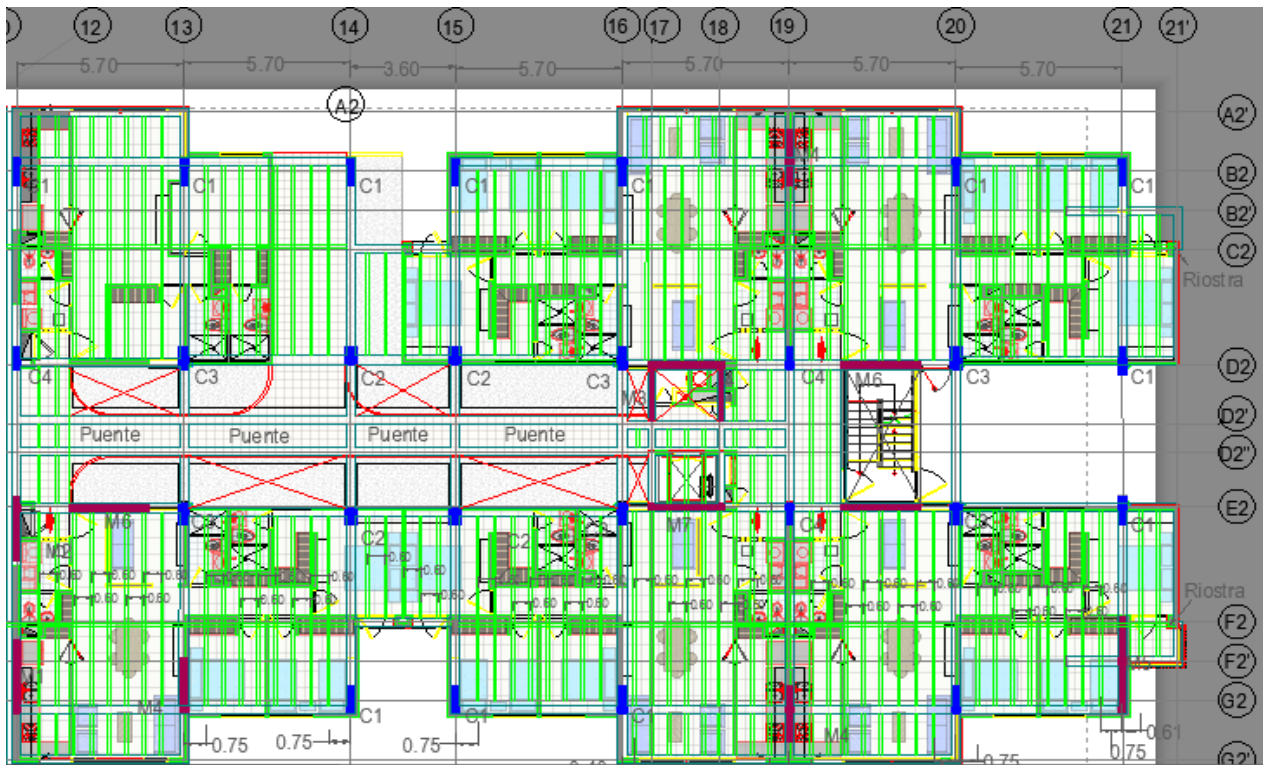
N+5.95m, entarimado, nivelación, replanteo de ejes y cimbrado, losa tipo.
